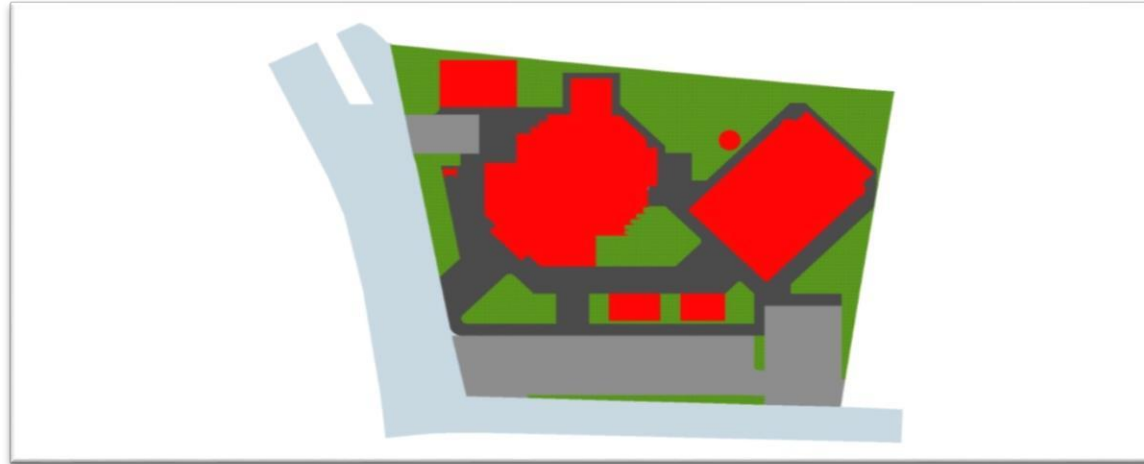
Vista en planta, Conjunto Arquitectónico.
